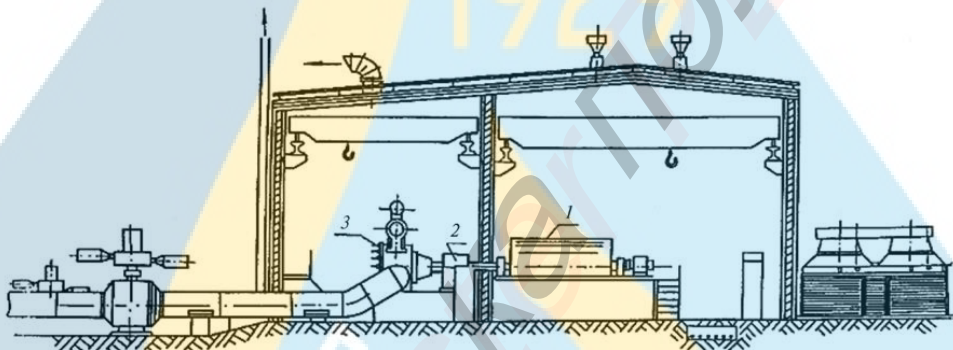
Принципова компоновка ЕГПА з СТД-4000-2 в будівлі компресорного цеху: 1 - електродвигун; 2 - редуктор; 3 - відцентровий нагнітач
